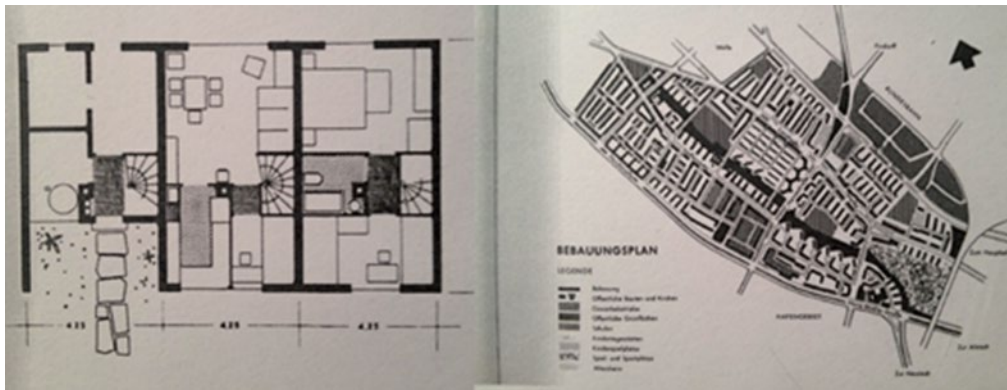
Bebauungsplan zum Neuaufbau der westlichen Vorstadt, Grundriss Reihenhäuser (Haslob & a., 1988)
